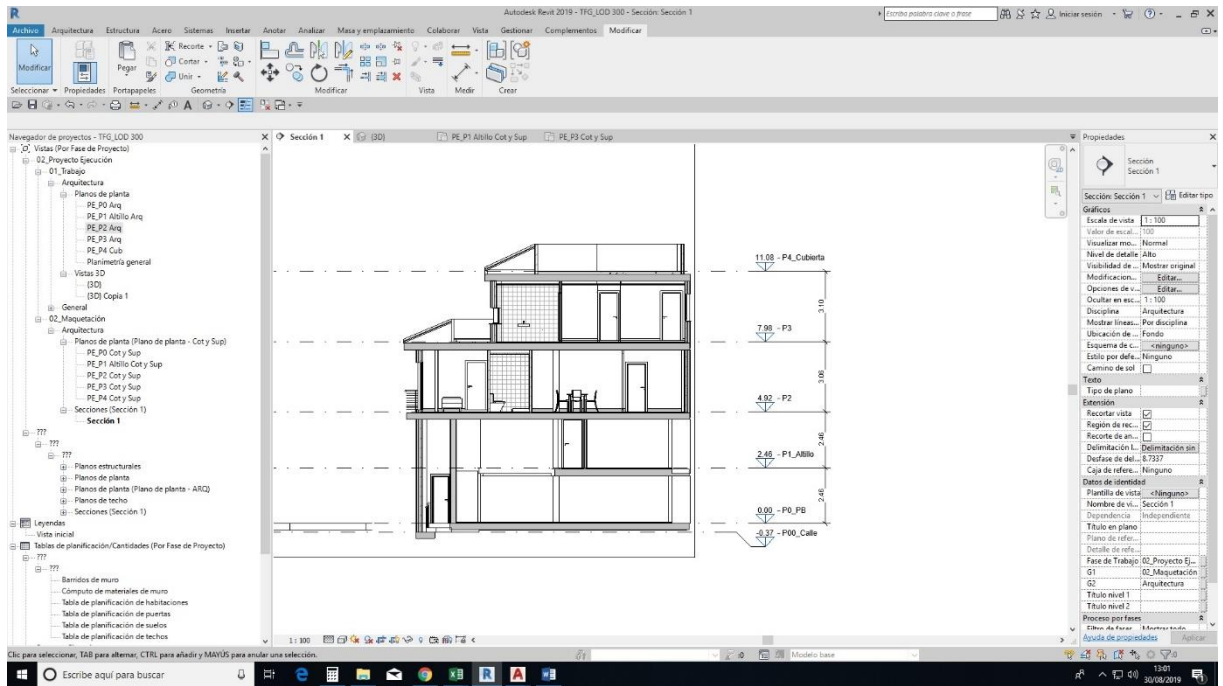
Alturas modificadas. Fuente: propia (2019)
